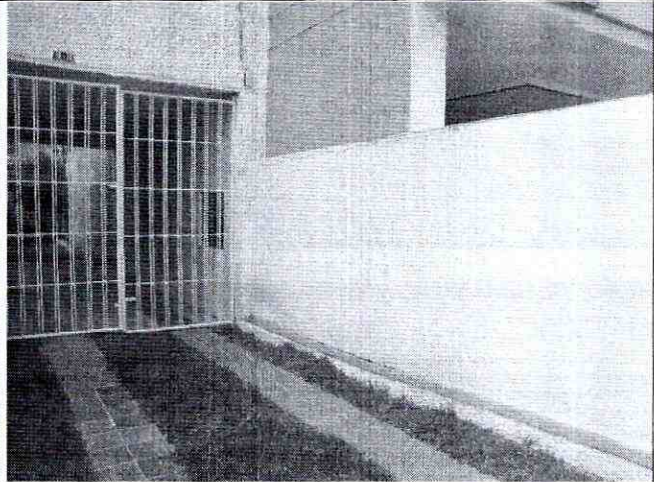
Vista del portón de acceso al parqueadero que presenta inclinación.
